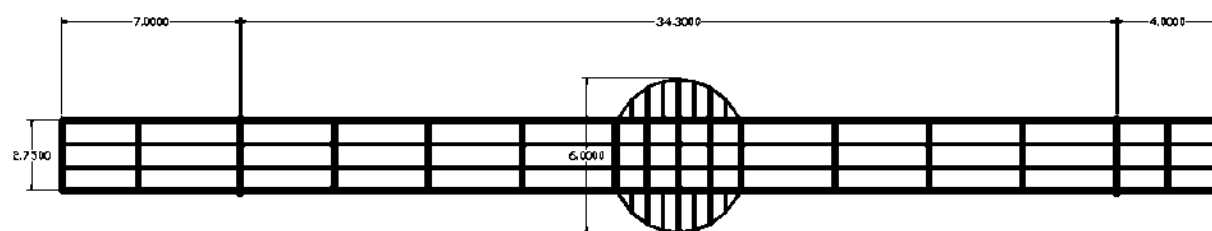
Detalle en planta del puente peatonal del ITSLR
